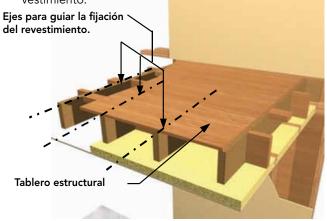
Trazado sobre el tablero base los ejes de las vigas secundarias.
